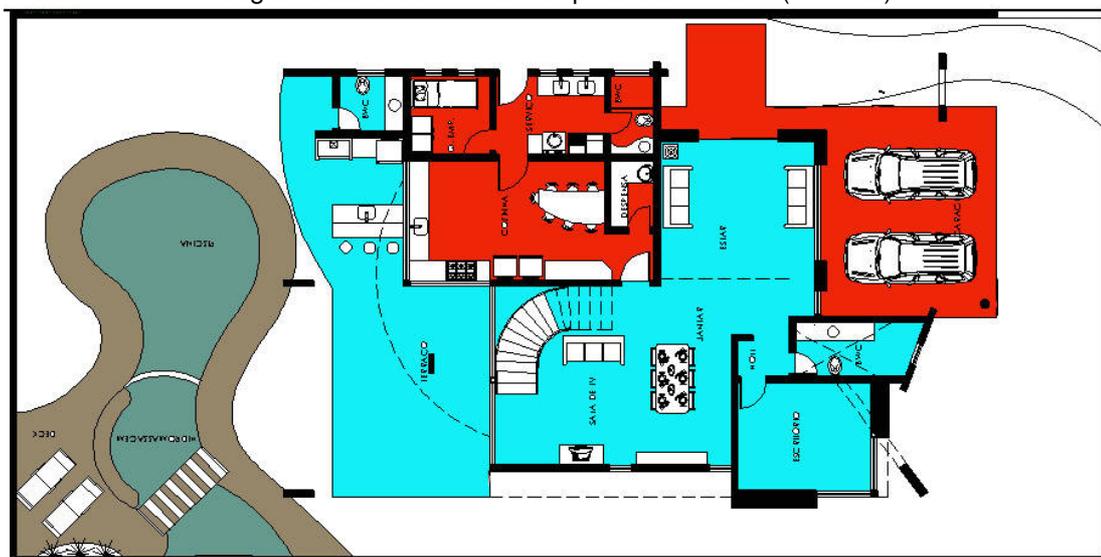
Planta baixa do pavimento térreo (casa 03)
